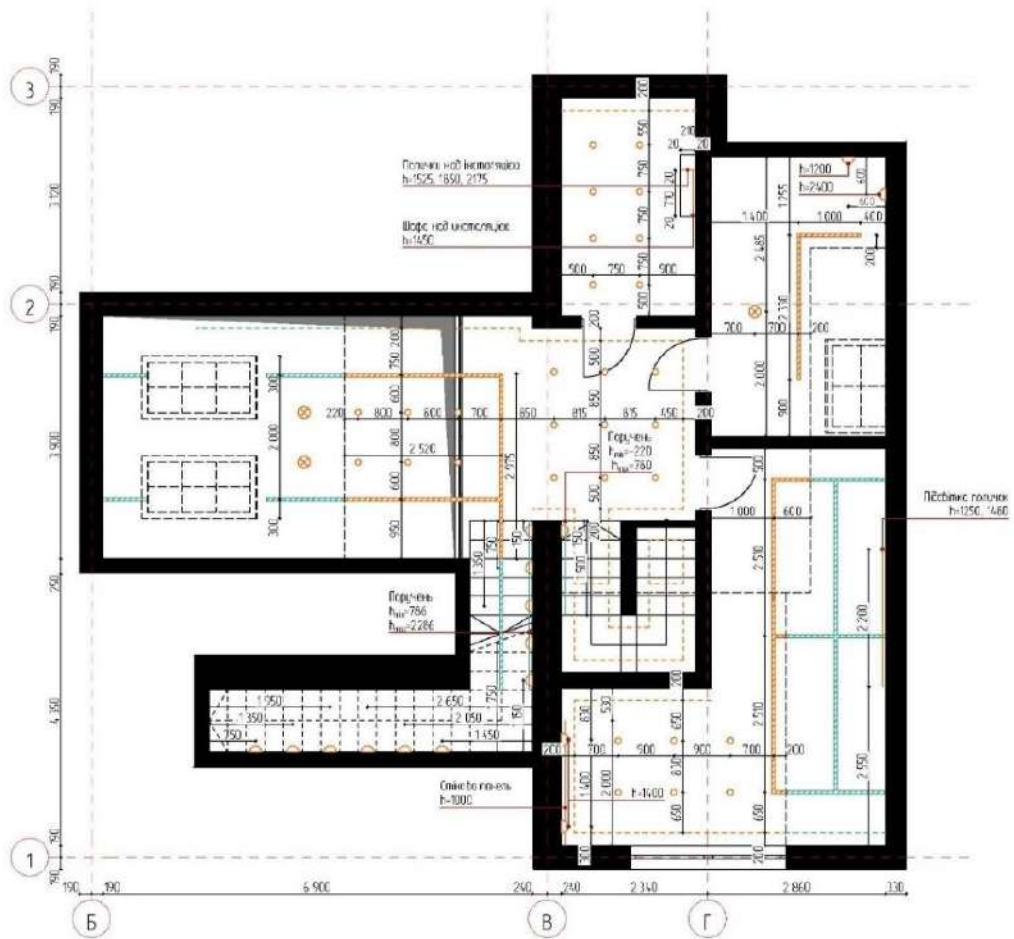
План розміщення світильників 2-го поверху (авторське креслення).
